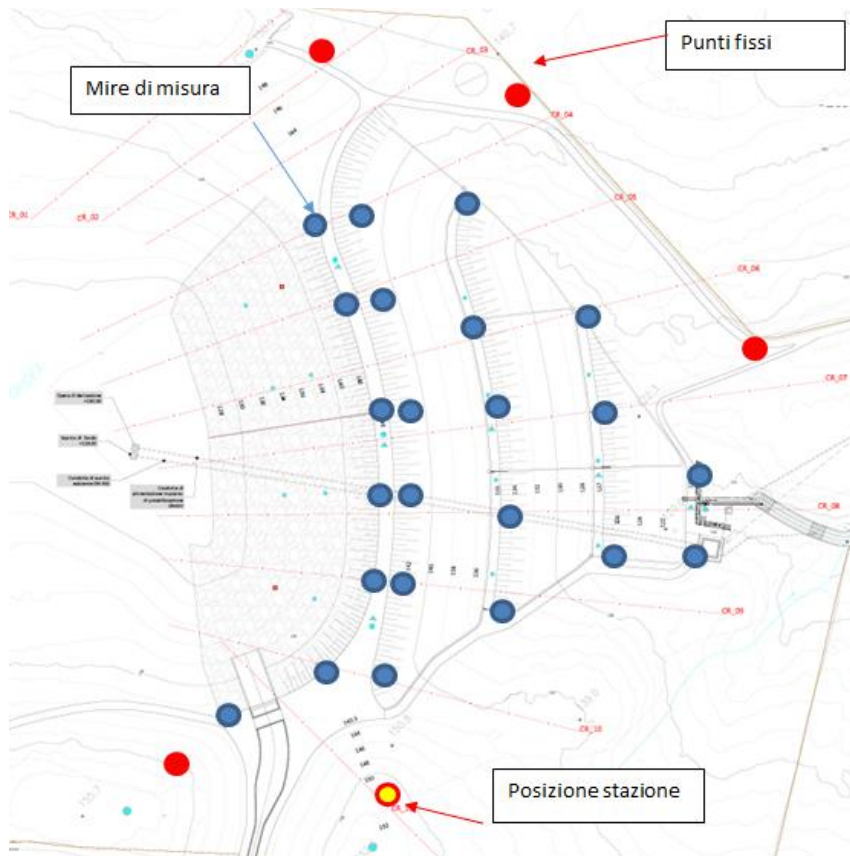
Planimetria ubicazione punti di controllo plano-altimetrici dello sbarramento
